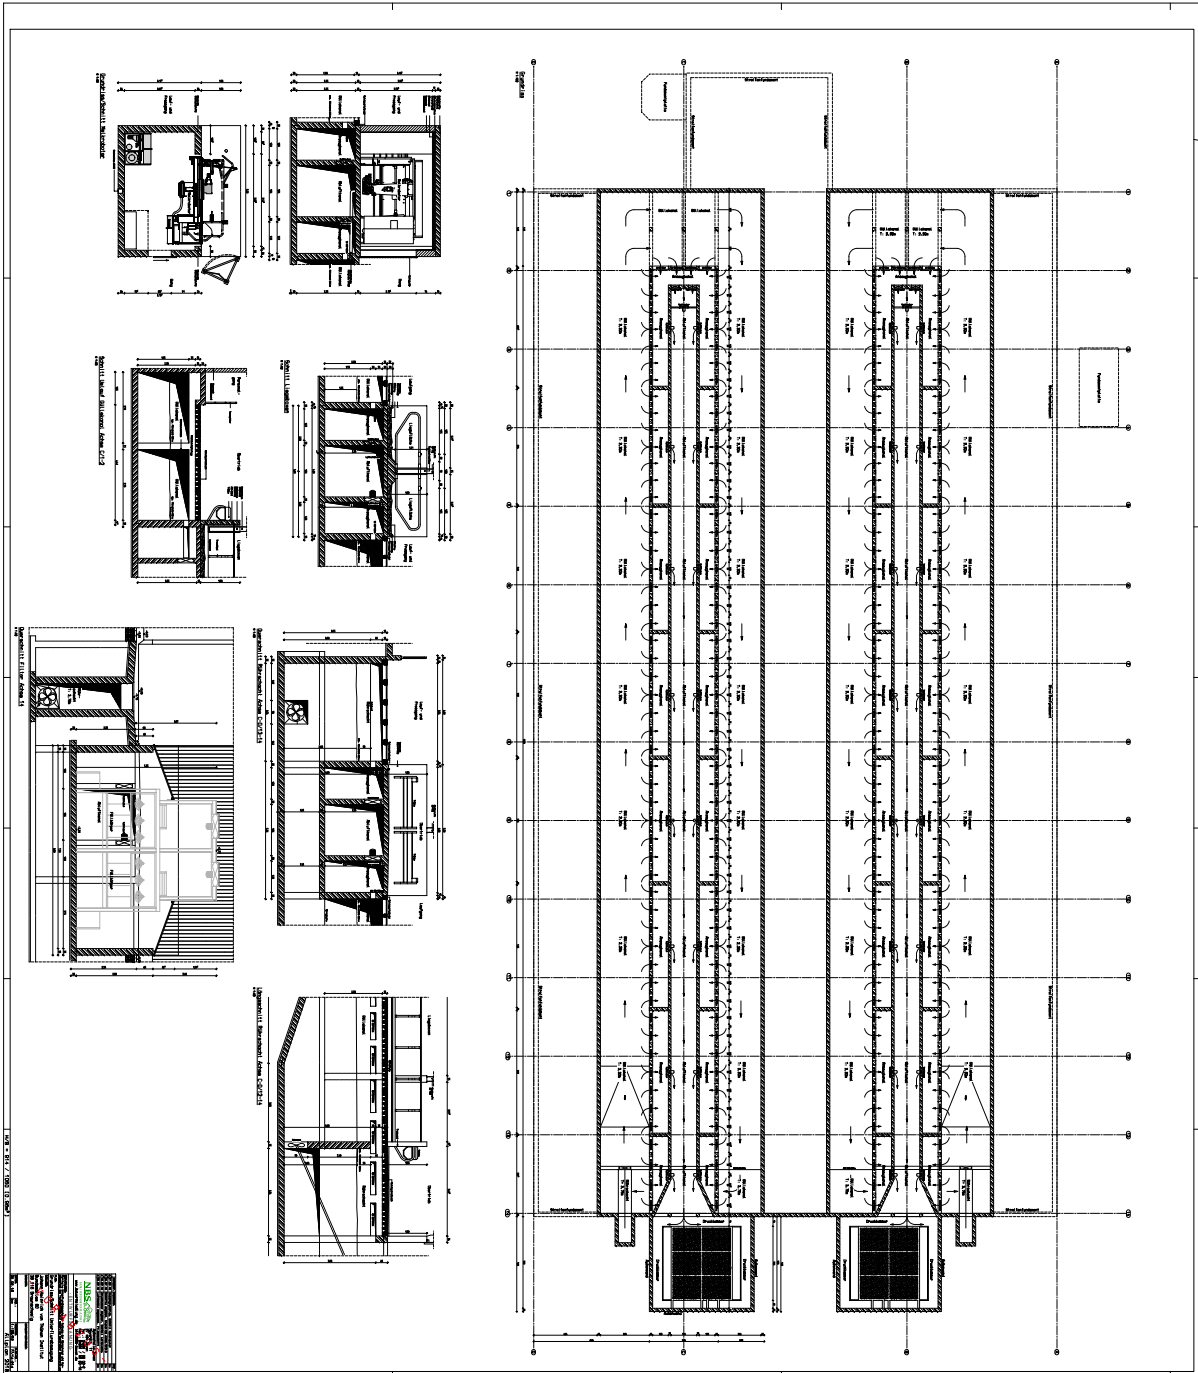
Grundriss und Schnitt Unterflurabsaugung Version 08
